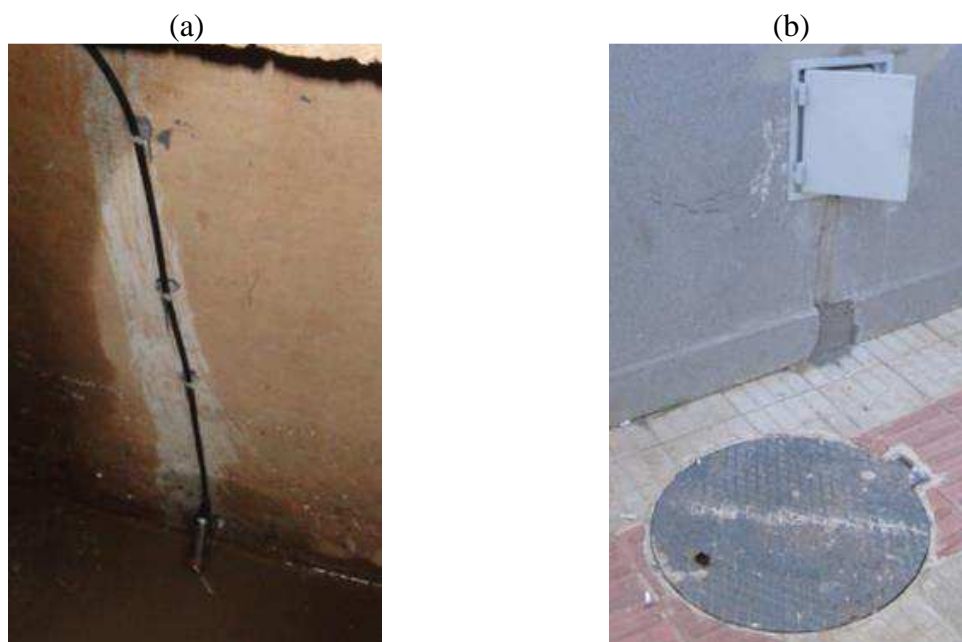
Equipamento instalado (a) Sensor de nível (b) Caixa com a bateria e o *data logger* e a tampa de inspeção
